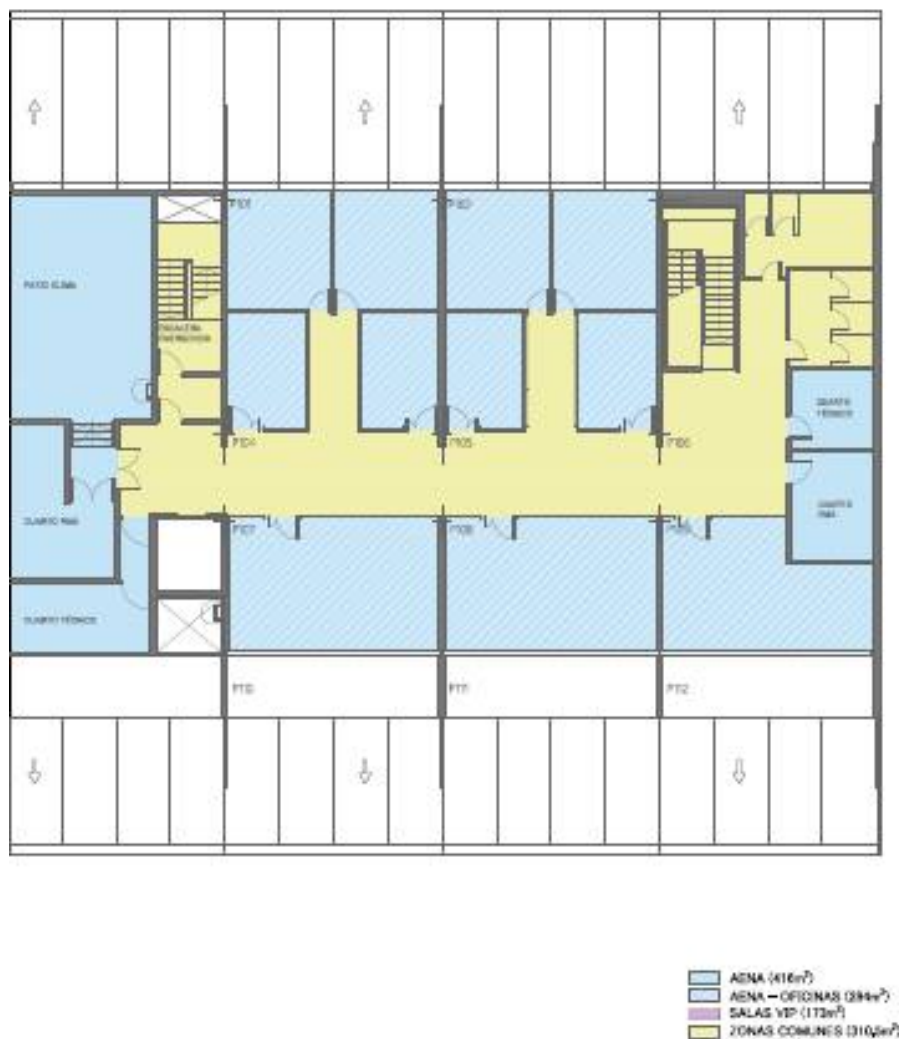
Vista en Planta de los Espacios de la Planta Superior
